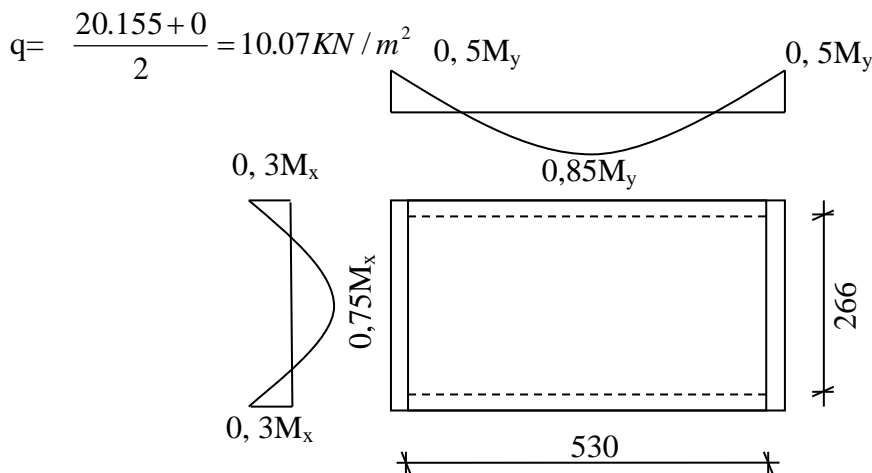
Panneau de dalle appuie sur 4 coté
